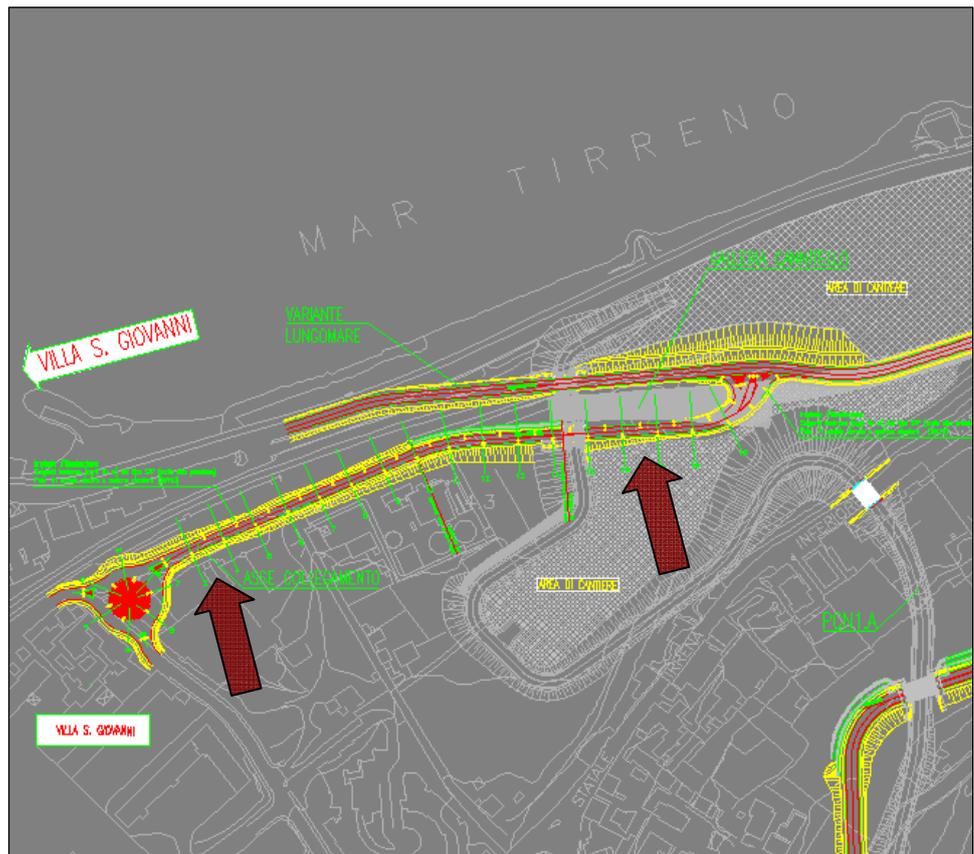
Planimetria di progetto “Asse Collegamento”
